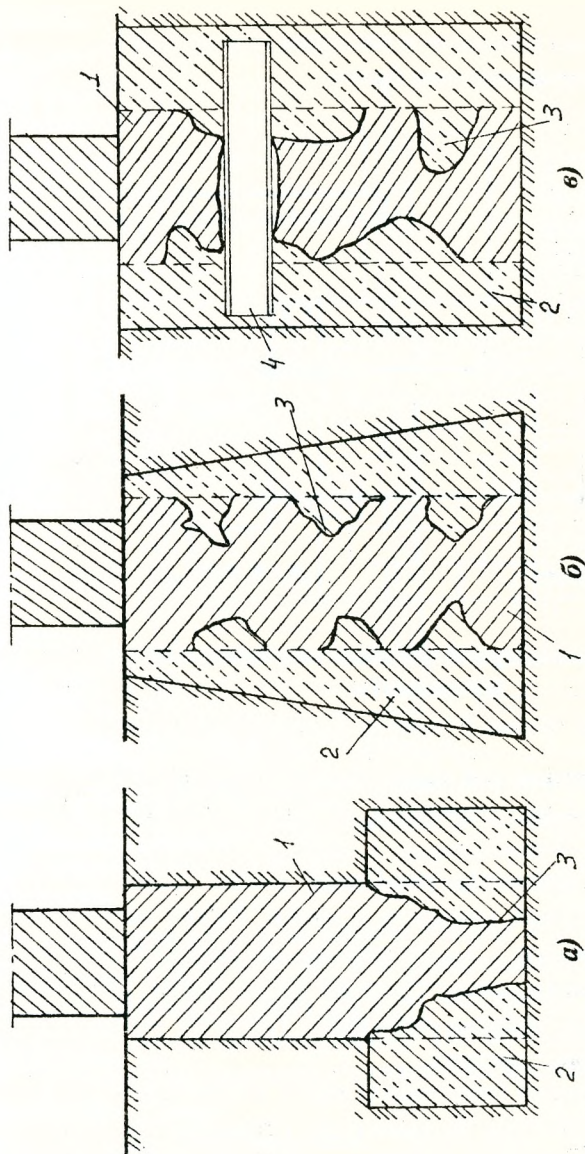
а. Усиление ленточных фундаментов бетонными обоймами.
